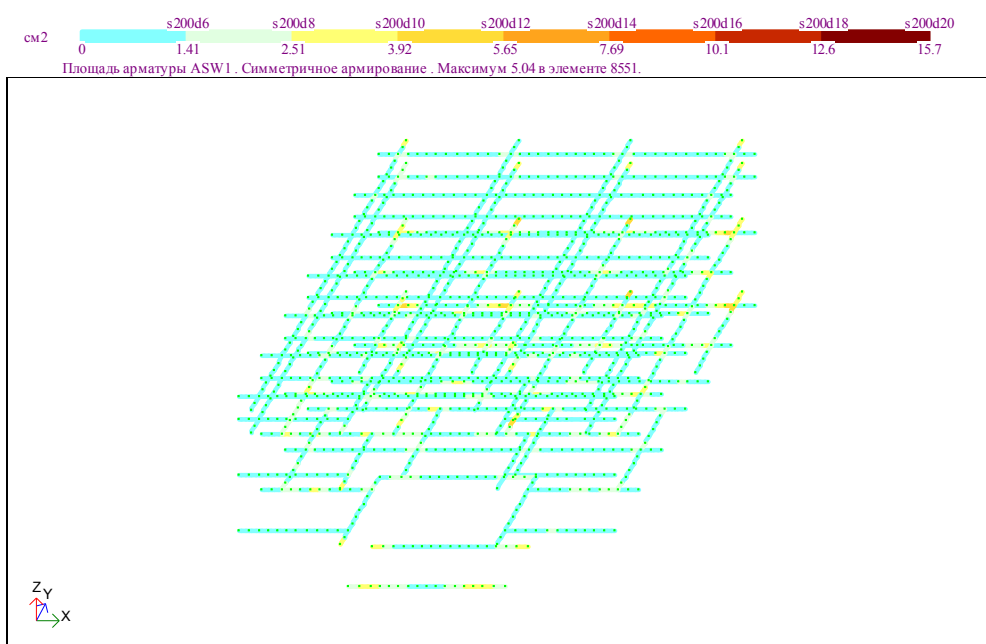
Поперечна вертикальна арматура ASW1
